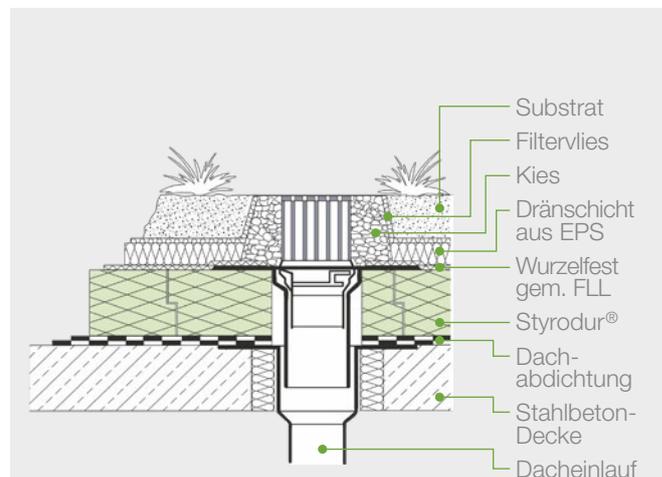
Dacheinlauf bei einem UK-Gründach mit einer Dränschicht aus EPS-Dränplatten.
